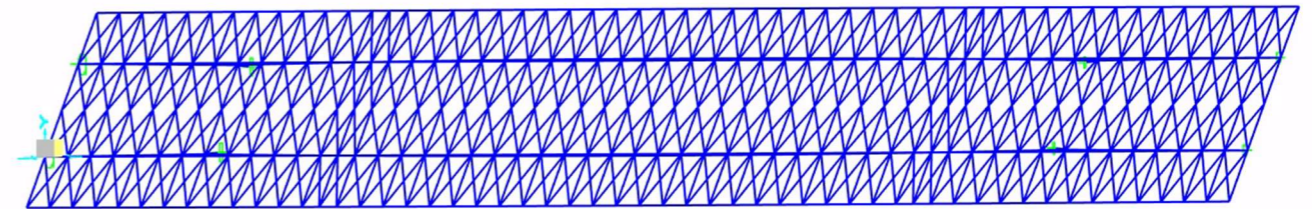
Vista en planta del modelo con las diagonales introducidas (fuente: elaboración propia)
